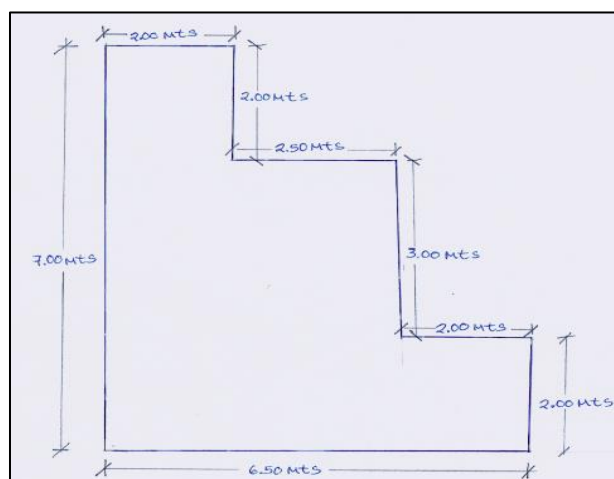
Planta arquitectónica de los campamentos. Fuente: Planos del proyecto.
